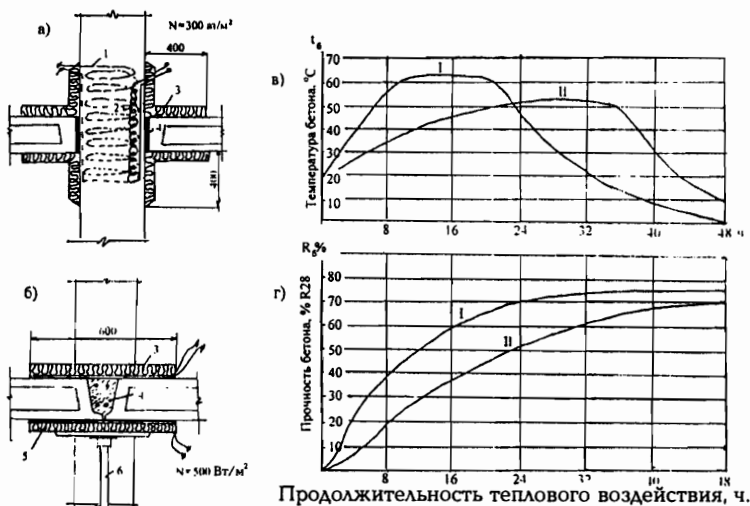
Технологические схемы и режимы прогрева стыкуемых элементов: а - колонн с плитами перекрытий; б - плит перекрытий с напрягаемой арматурой; 1 - греющие провода по периметру колонны; 2 - то же, с периферийным расположением в виде спирали; 3 - утеплитель; 4 - монолитный участок; 5 - термоактивная палуба; 6 - поддерживающие стойки; в - графики нагрева элементов стыков и бетонной смеси; г - интенсивность набора прочности бетона при режиме прогрева I с удельной мощностью 500 Вт/м<sup>2</sup>; и режиме II с удельной мощностью 300 Вт/м<sup>2</sup>
